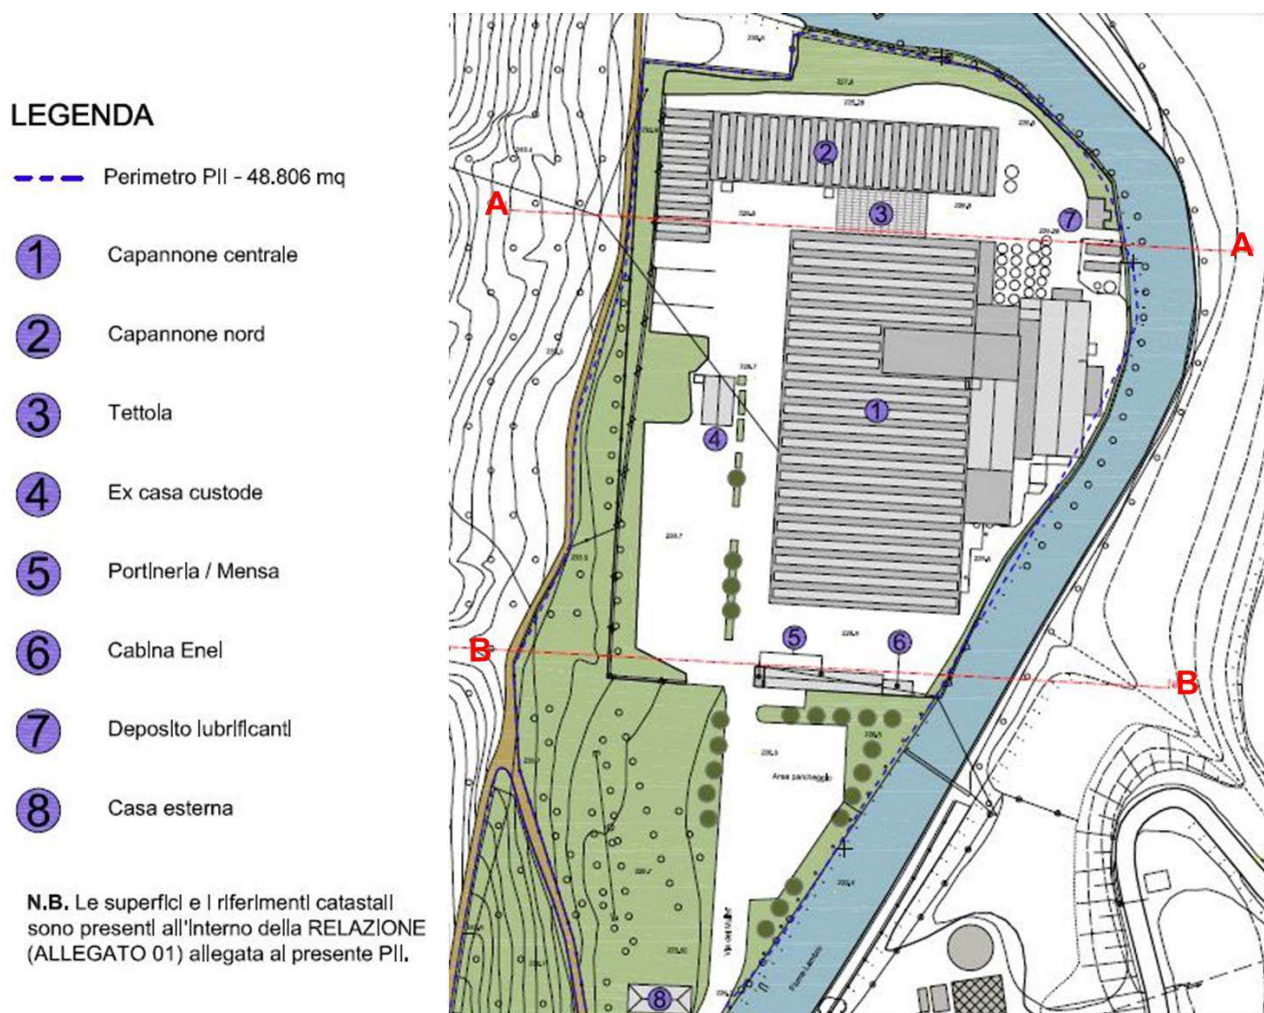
Stralcio elaborato di progetto Tav. 1 Stato di fatto ditta LAMPLAST
